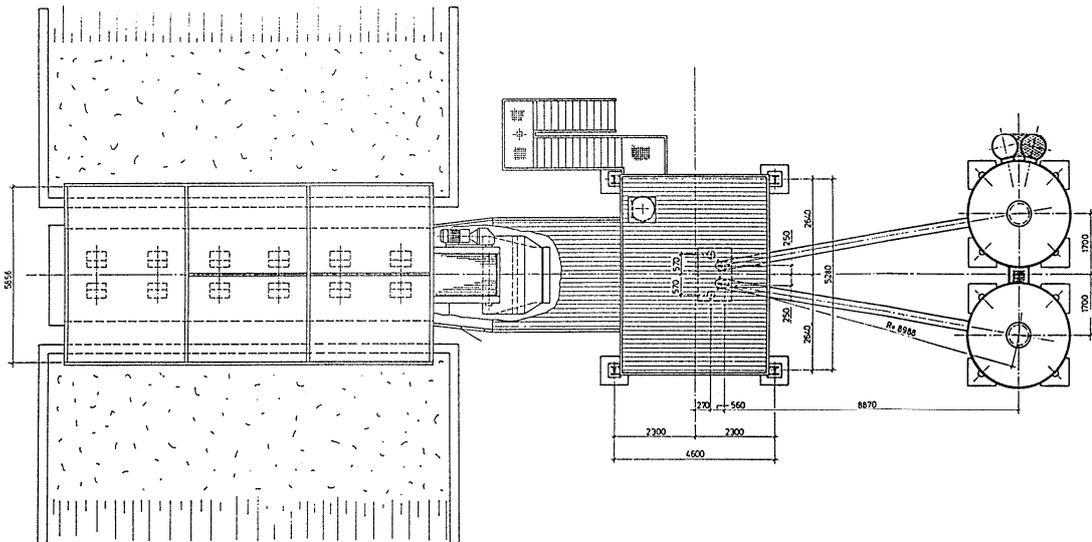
Baustellen-Horizontalsilo-Betonmischanlage ELBA Modul-Anlage EMA D 85/105/110 [7]
